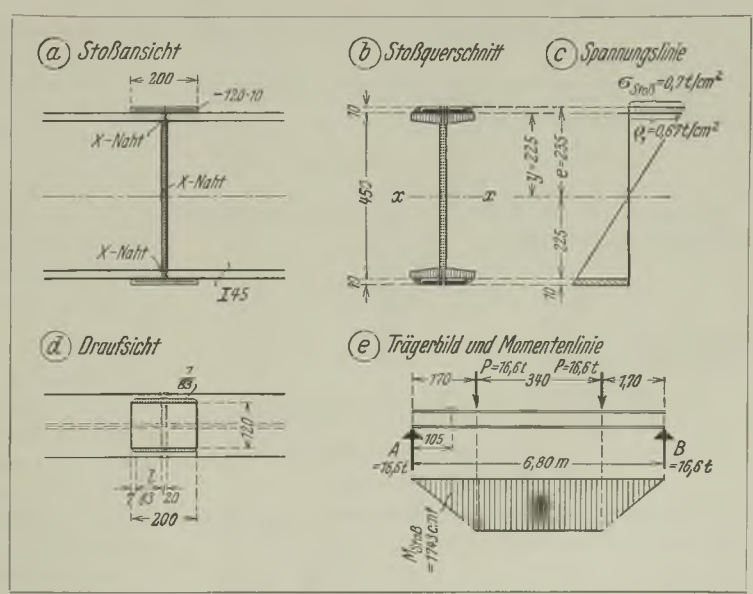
Trägerstoß mittels voller Stumpfschweißung und Flanschlaschen.
